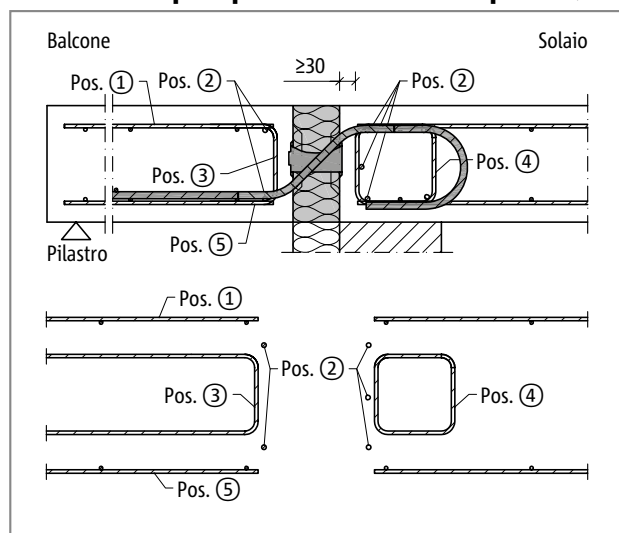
Schöck Isokorb® tipo Q40M - Q60M, armatura in opera
